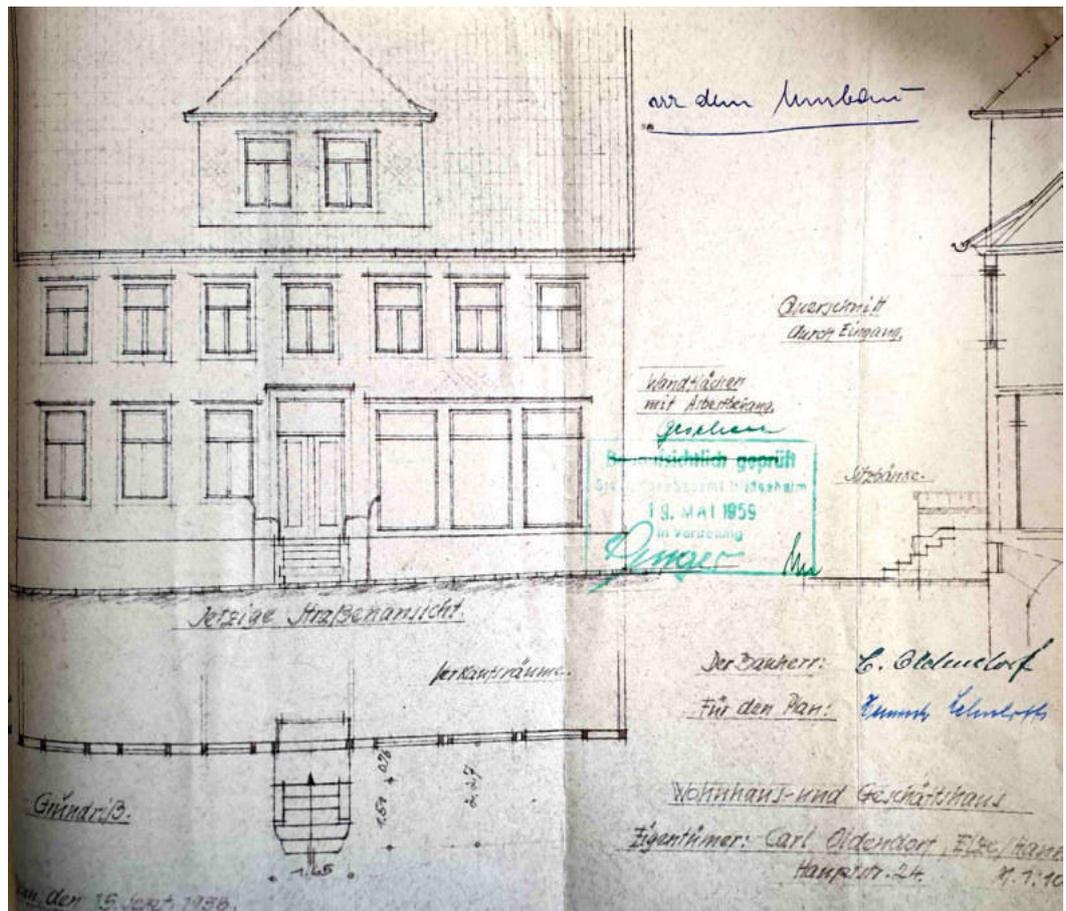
Fassadenansicht und Teilschnitt vor der Errichtung des Ladenvorbaus, 1959. An Stelle des Vorbaus existieren bereits drei hohe Ladenfenster.
